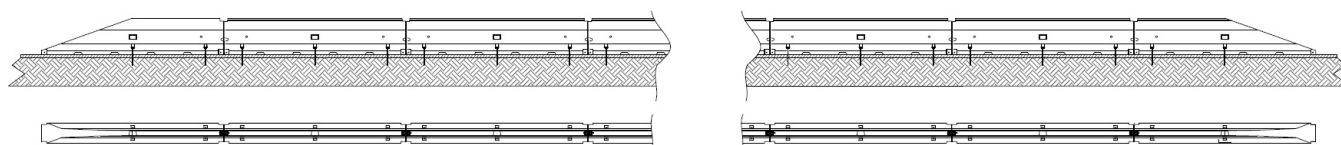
Installazione barriera Abesca H120 W2 FAST
